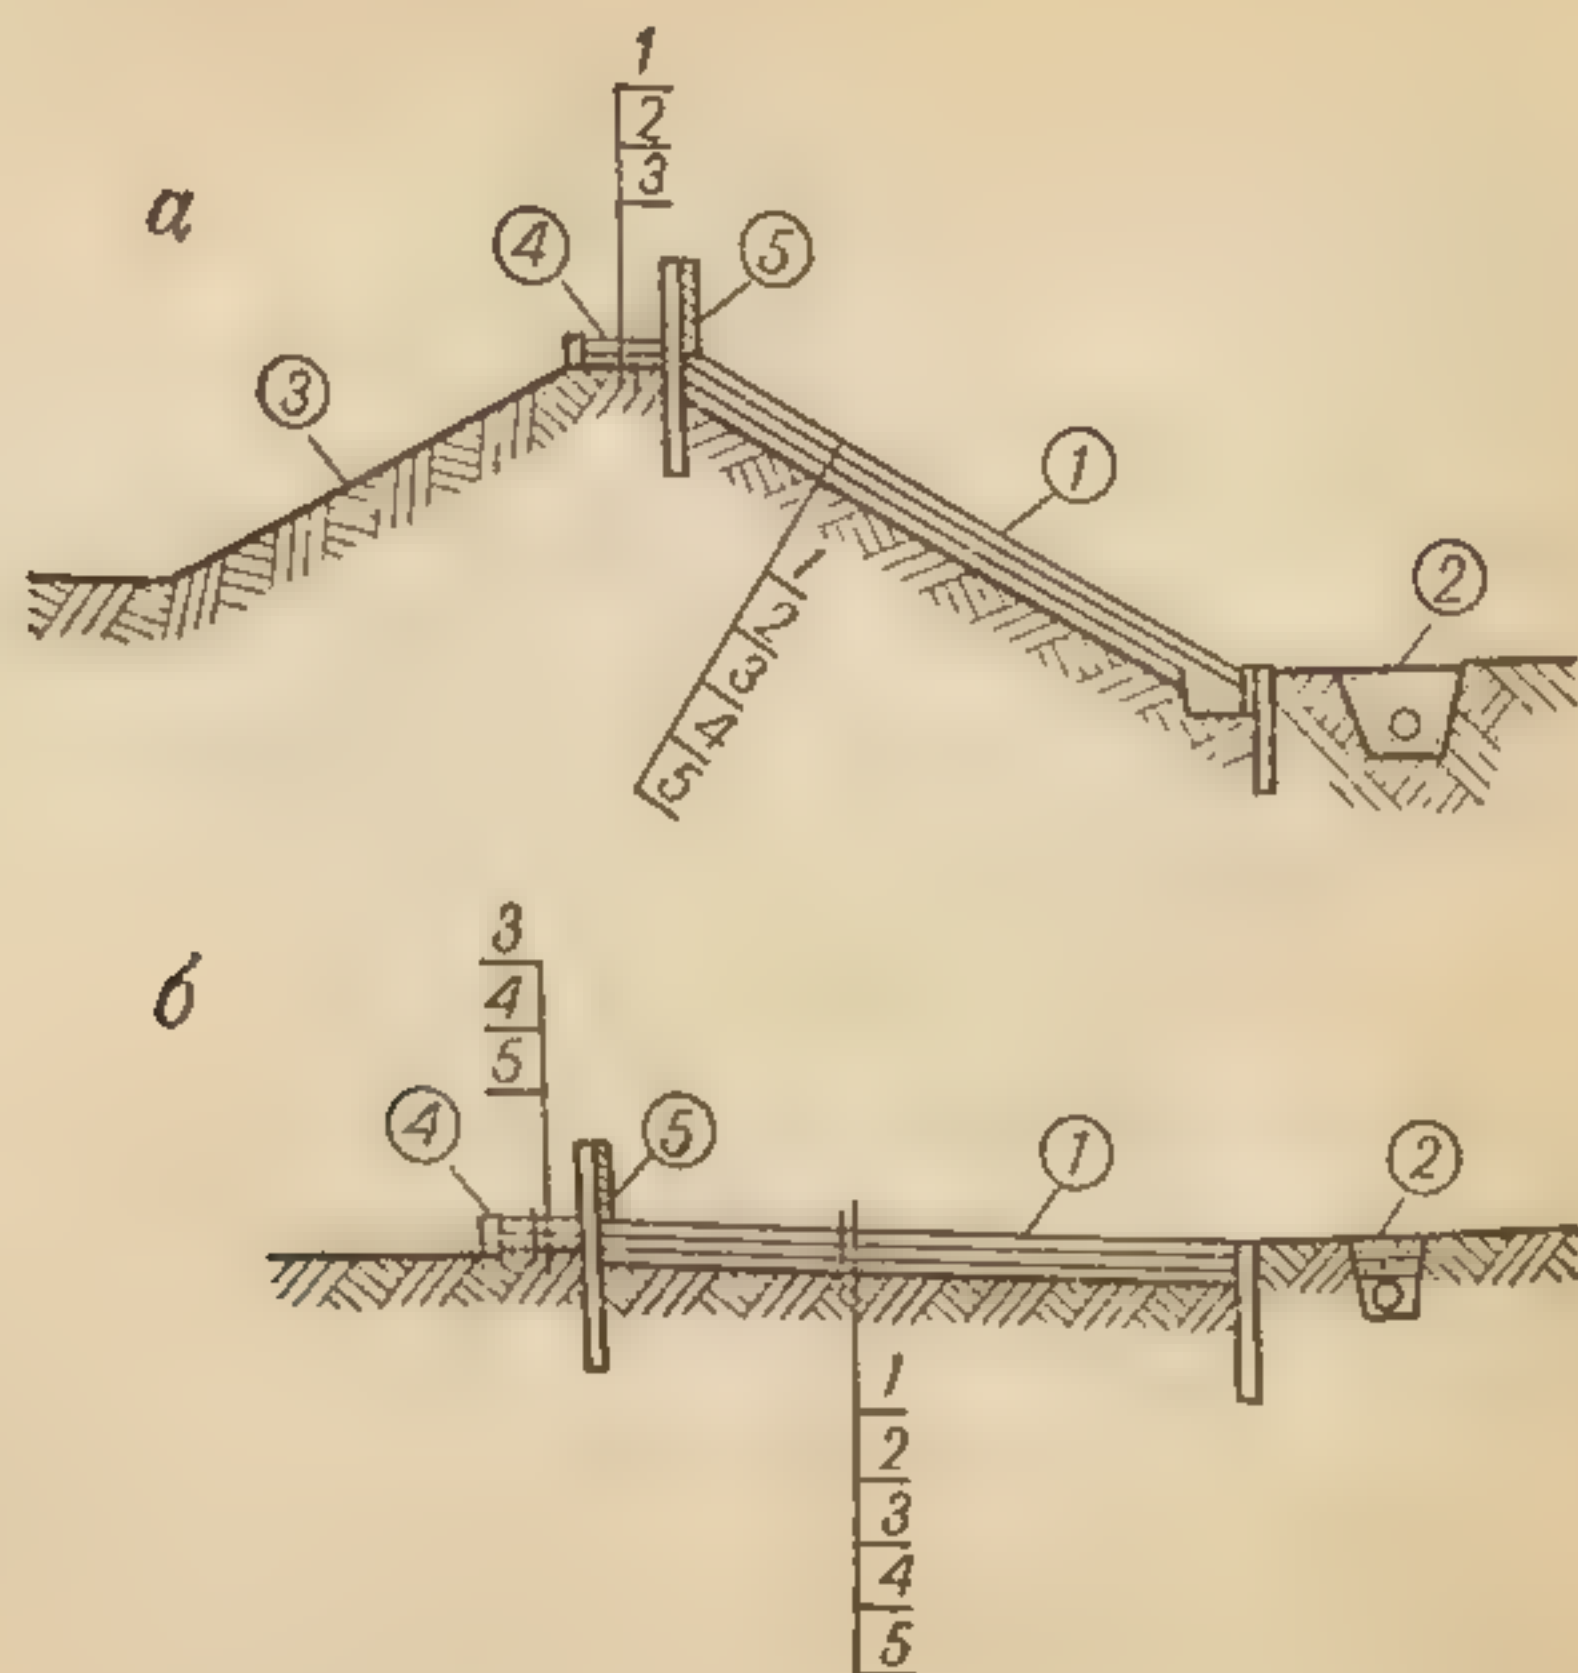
Конструкция трекового полотна с бетонным покрытием:
